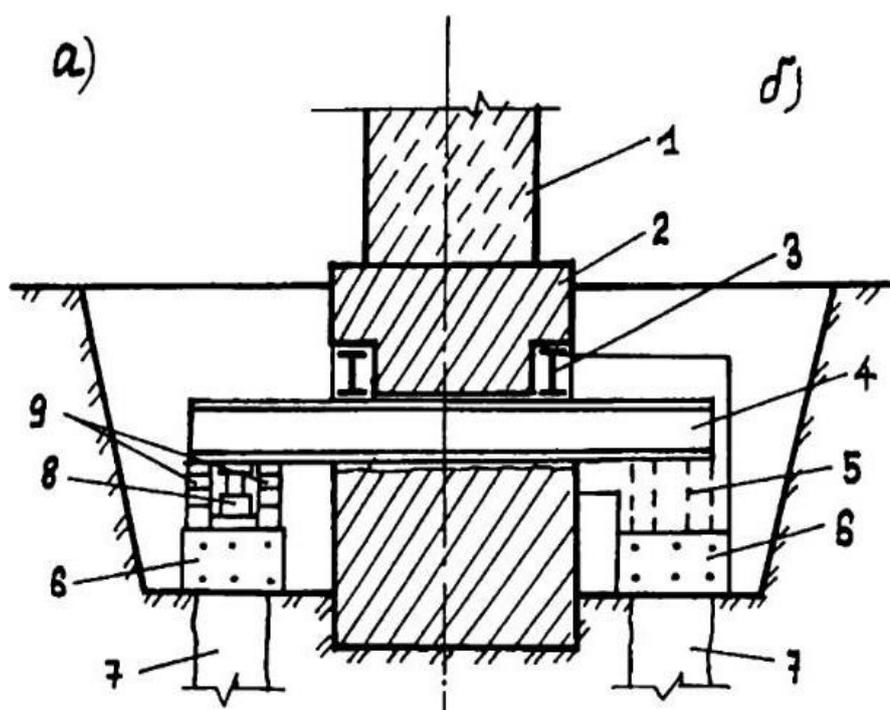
Схема усиления ленточных фундаментов буронабивными сваями (а – в период задавливания домкратами свай; б – после окончания работ): 1 – стена; 2 – фундамент; 3 – продольные балки в пробитых бороздах; 4 – поперечные балки; 5 – бетон омоноличивания; 6 – ростверк; 7 – свая; 8 – домкрат; 9 – подклинка.
